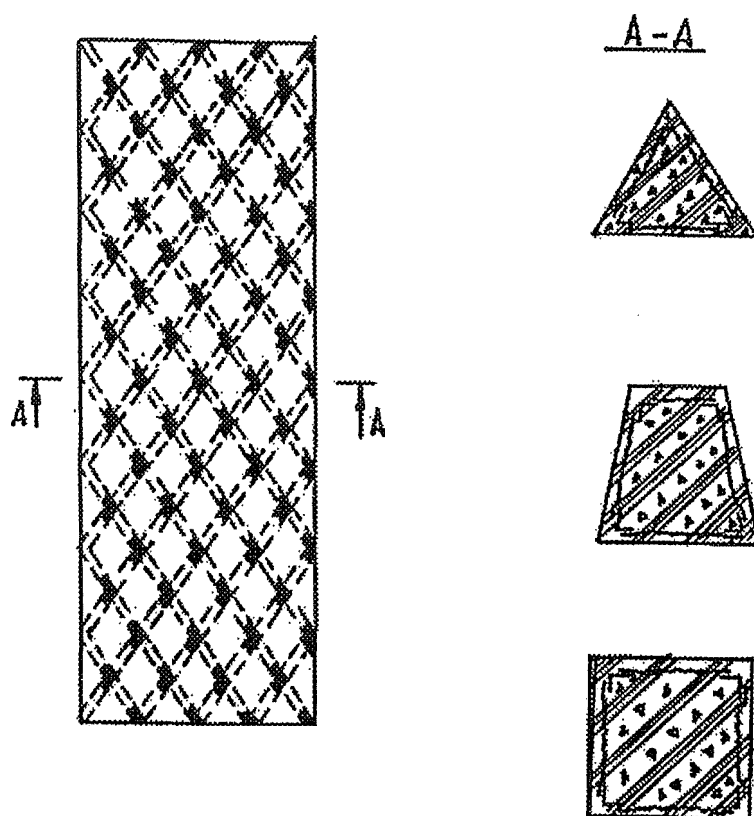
Железобетонный элемент (А.С. СССР №1571168)
